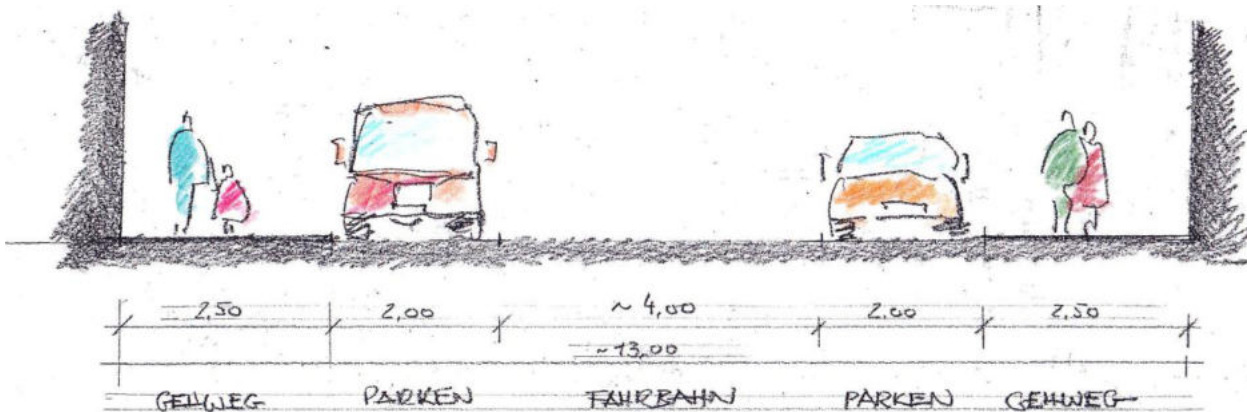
, Skizze Straßenquerschnitte Breite Straße mit Aufteilung der Verkehrsflächen
